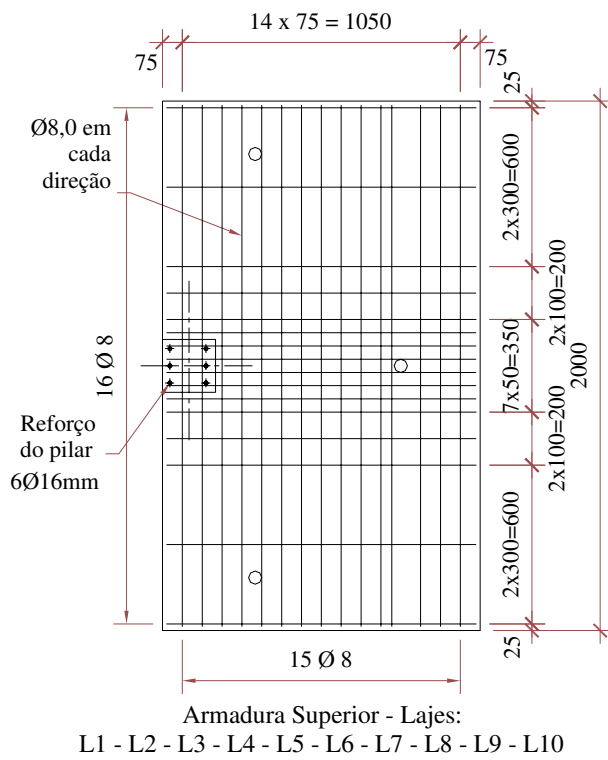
Disposição da armadura passiva superior das lajes L1 até L13 em planta (mm)
